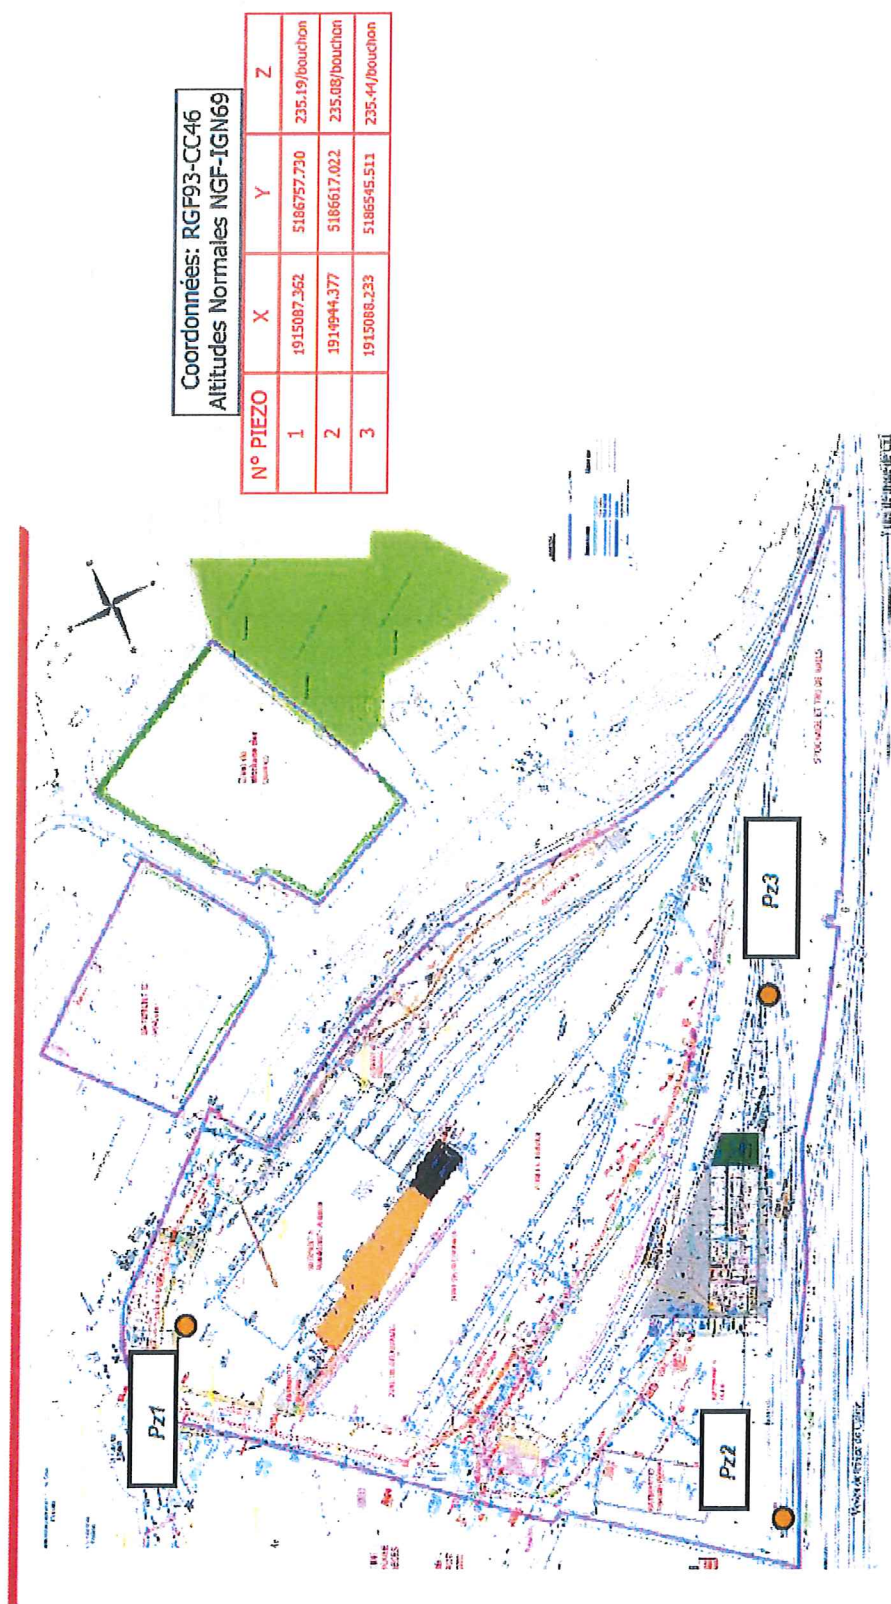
Localisation des ouvrages piézométriques (Source : fond de plan - Fontaine TP)
